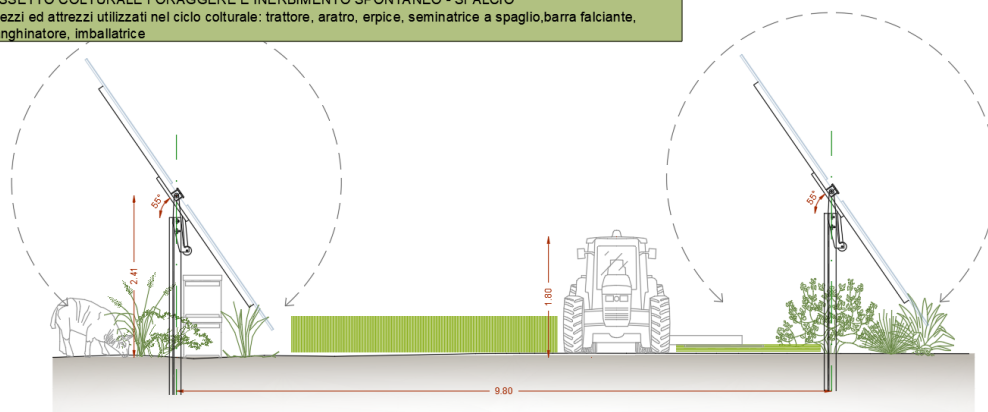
Assetto colturale foraggiere e inerbimento spontaneo – Attività di sfalcio
